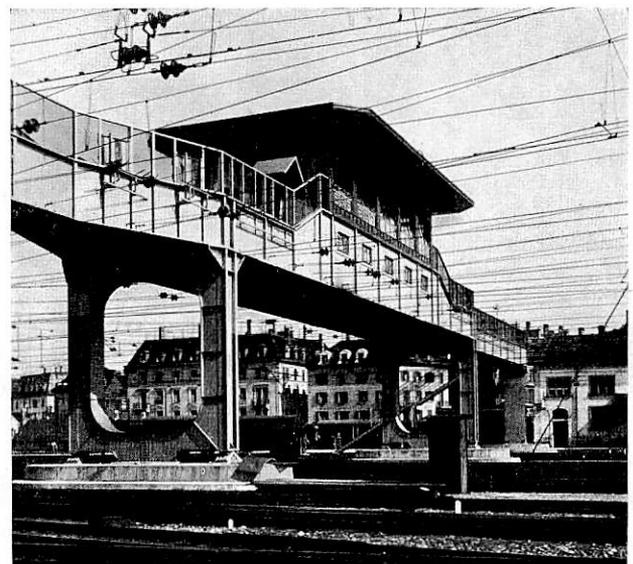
Geschweißte Stellwerkbrücke im Bahnhof Zürich.
